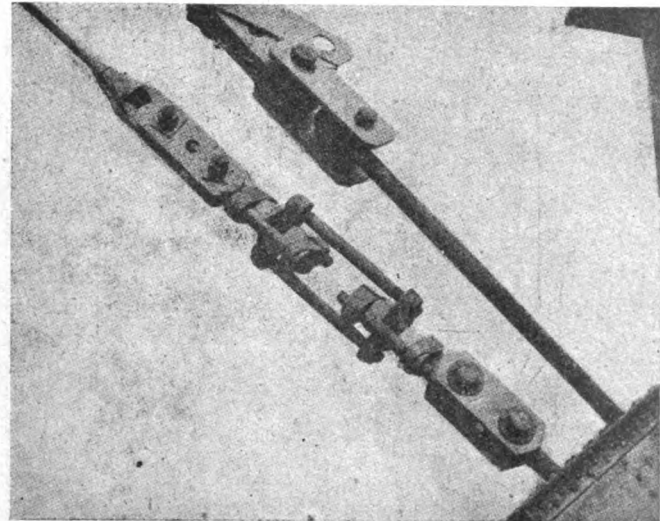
Speciali dispositivi isolanti per l'interruzione degli stralli.
